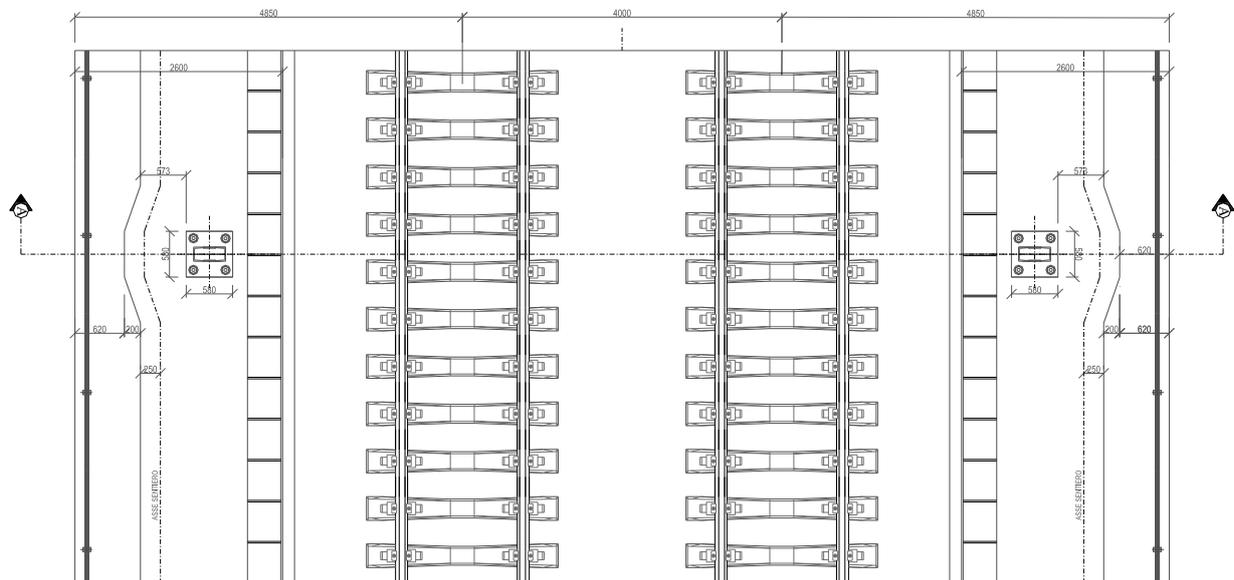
Stralcio planimetrico sezione tipo ferroviaria ponte a doppio binario
